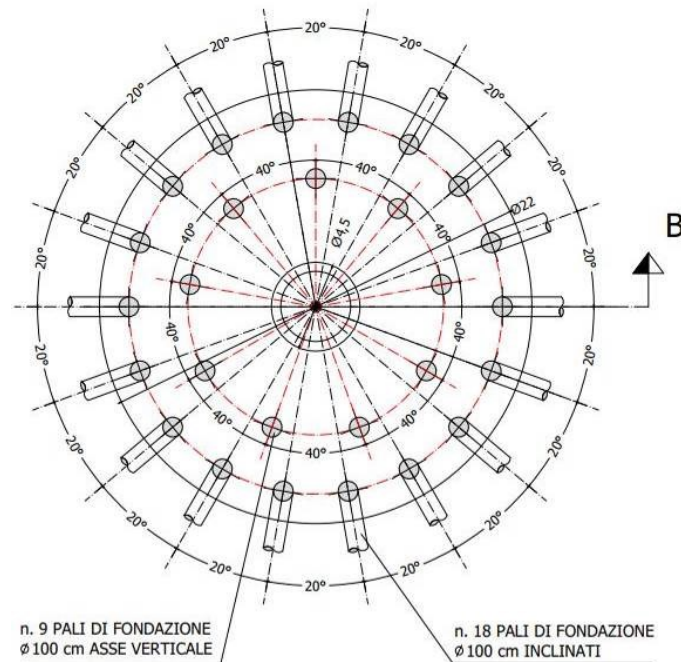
Schema strutturale delle fondazioni profonde – pianta piastra circolare e pali
